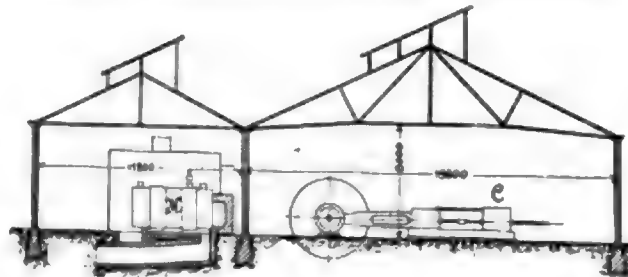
Querschnitt durch Kessel- und Maschinenhaus.
